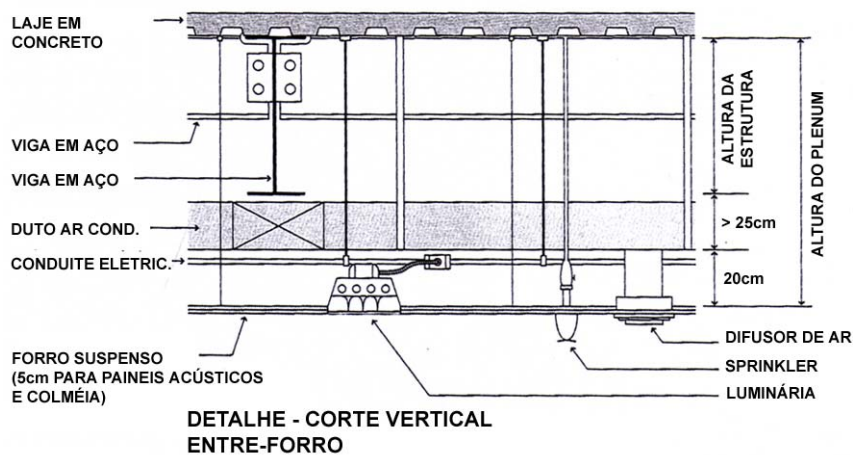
Detalhes de coordenação entre iluminação, instalações, forro e estruturas (EGAN, 2001).
